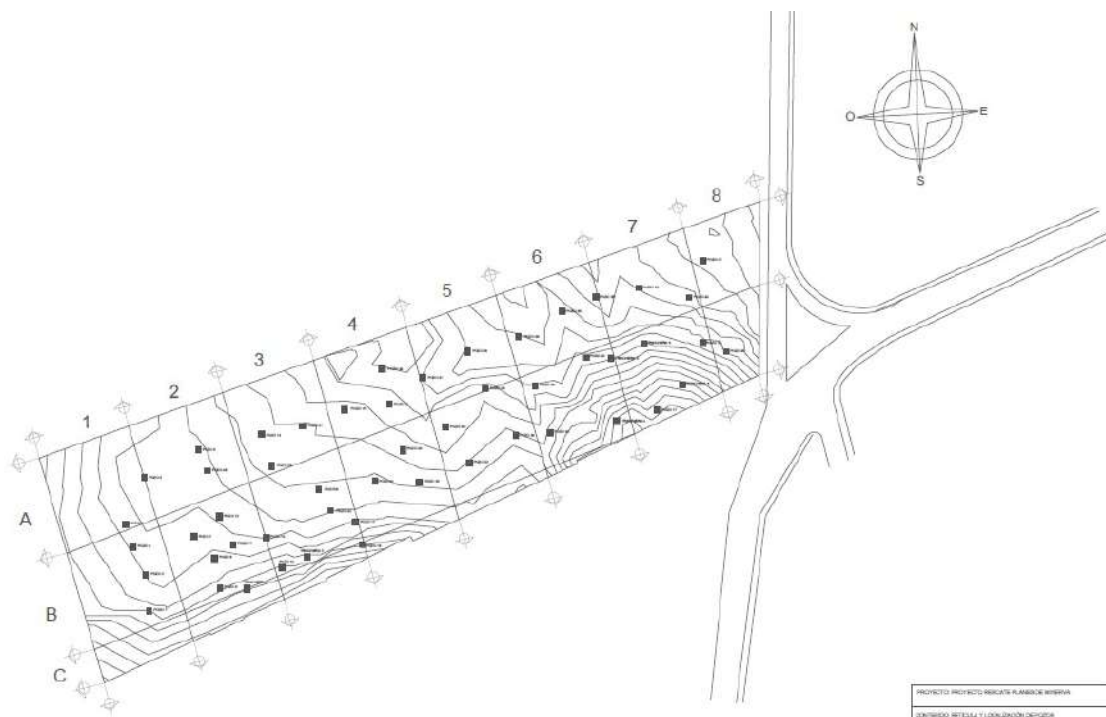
Plano del terreno con la ubicación de pozos excavados.
